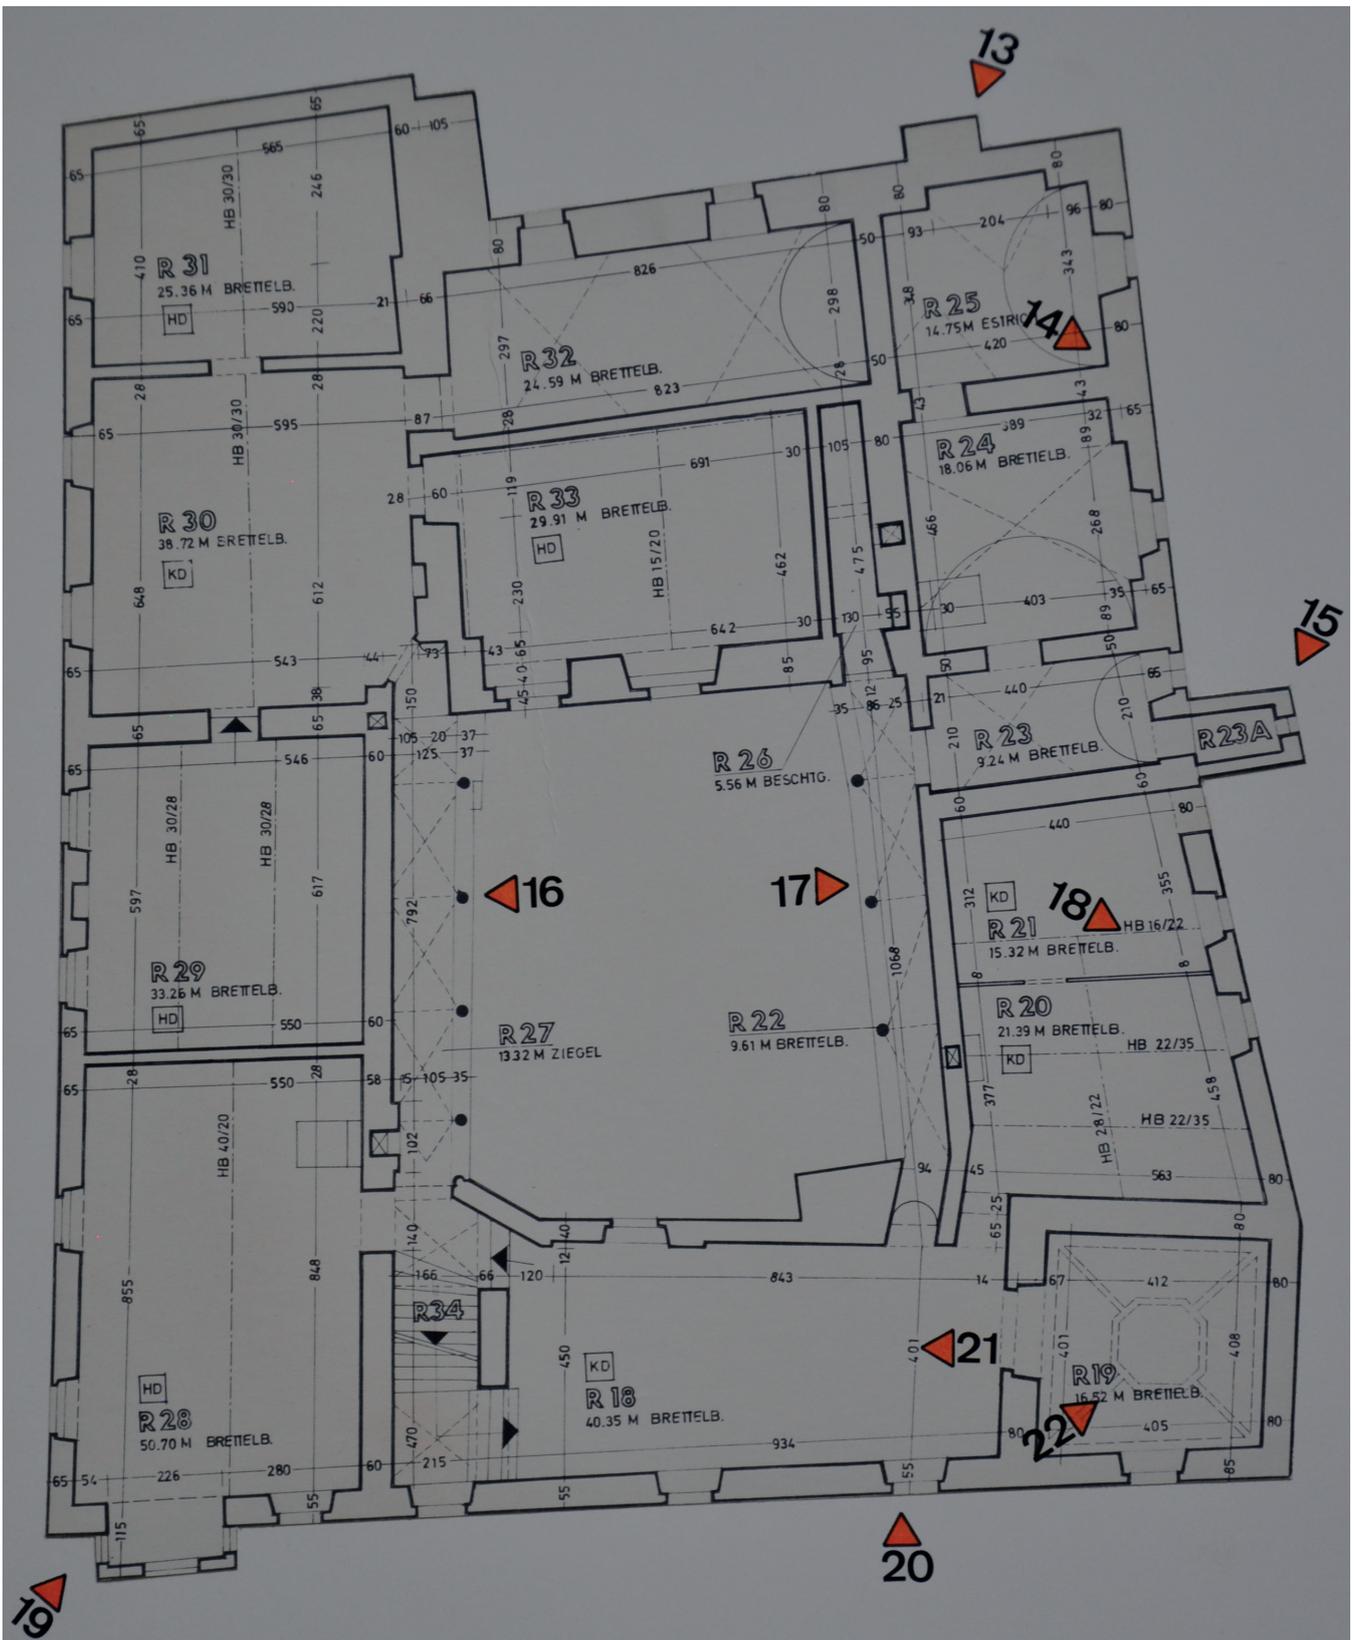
Aufnahmewinkel der Bauschäden am Grundriss des 1. Obergeschosses
